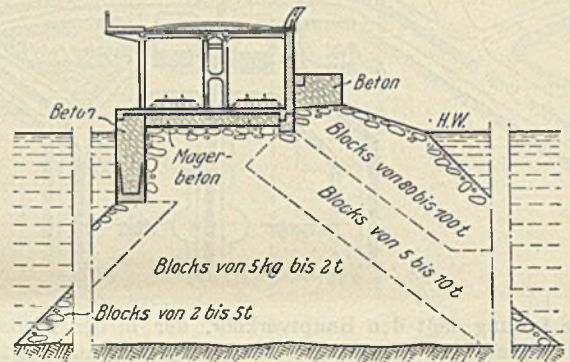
Deichquerschnitt bei geringeren Wassertiefen.
